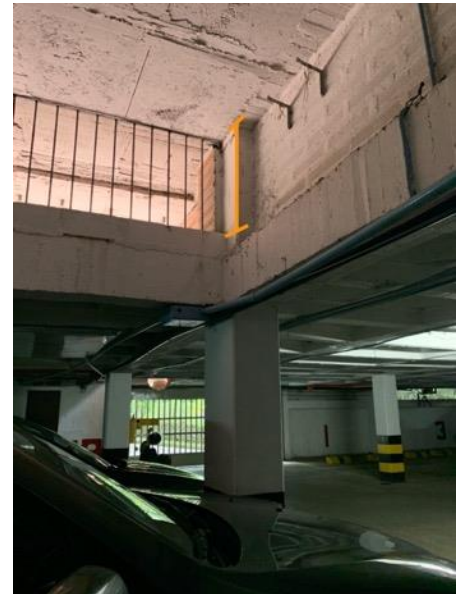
Columnas cortas en parqueaderos TB 2.
